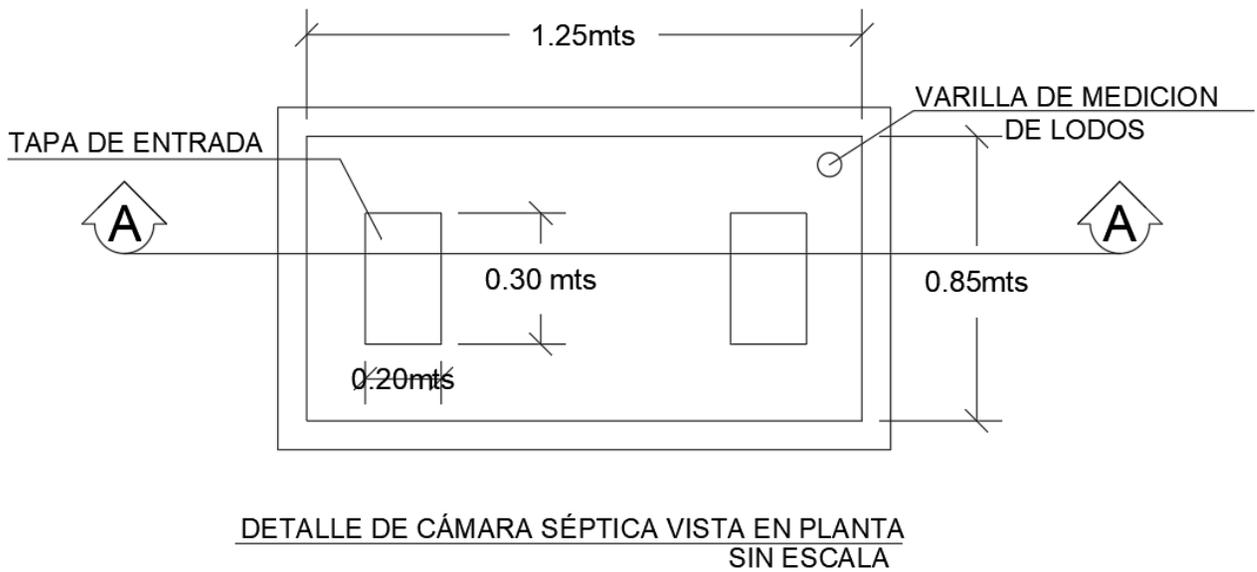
Vista en planta de las medidas para cámara séptica. Fuente. Creación propia
